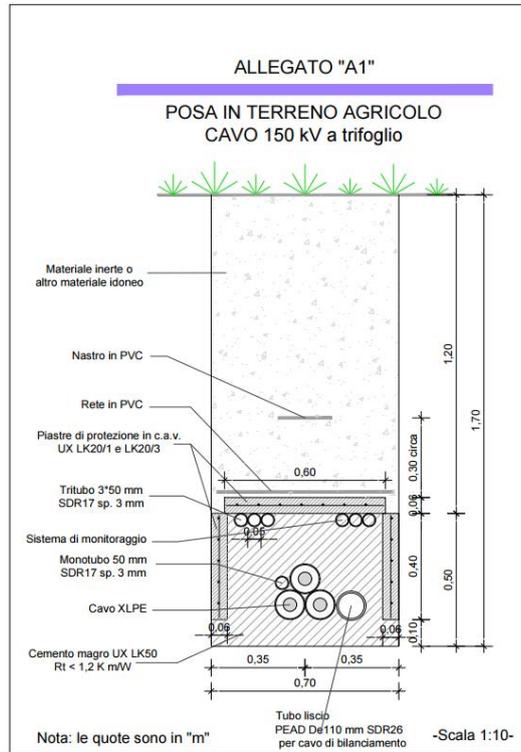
Sezione tipo trincea posa elettrodotto cavo interrato
